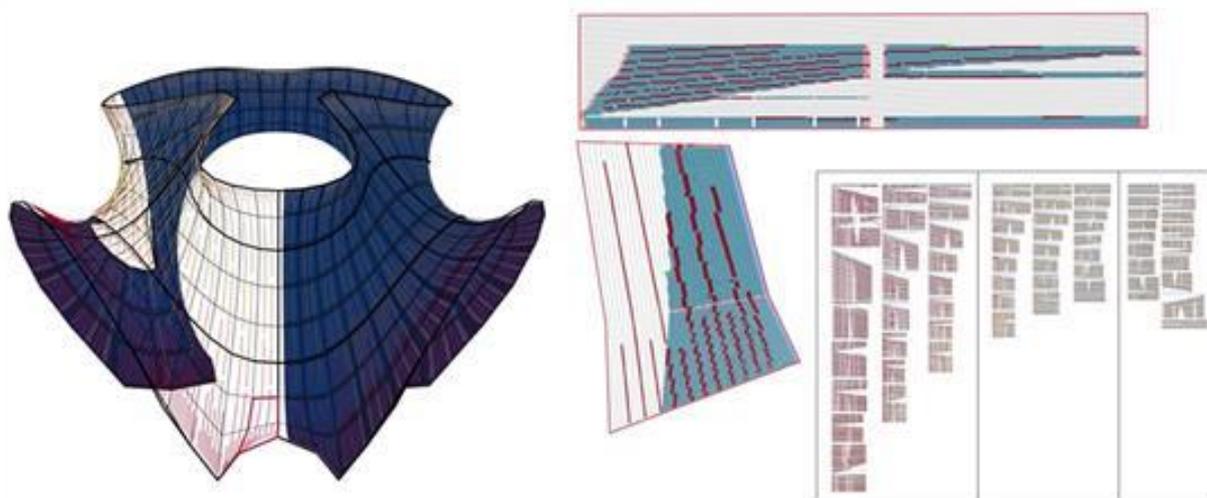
Projeto KnitCandela – projeto malha estrutural.
